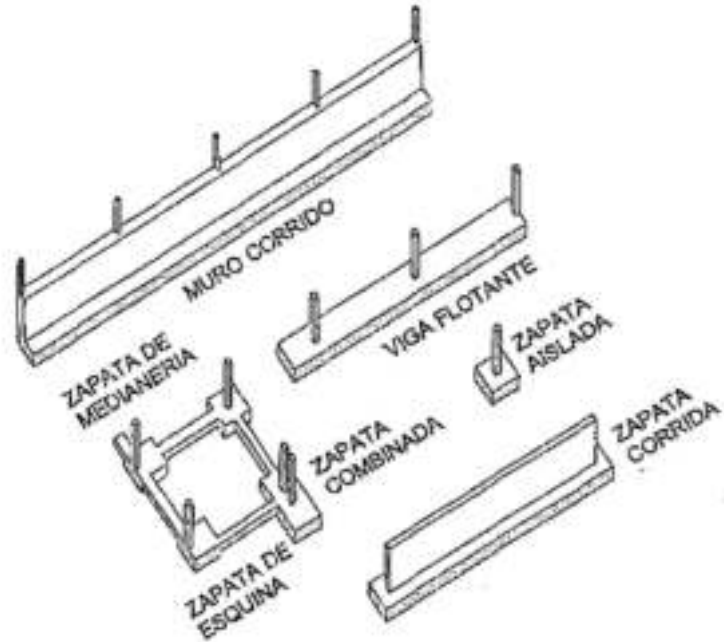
Tipos de Cimentaciones Superficiales (zapatas y vigas)
